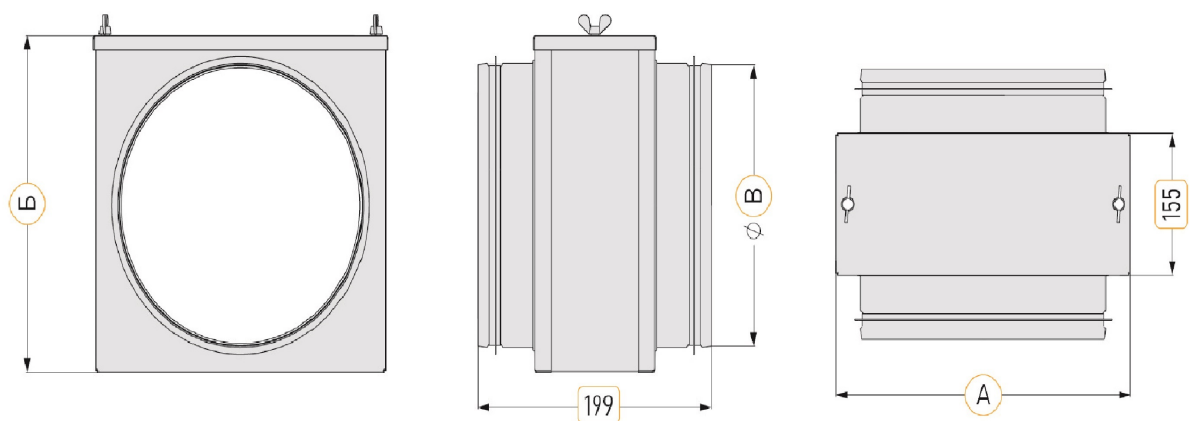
Внешний вид и основные размеры фильтров ККФ
